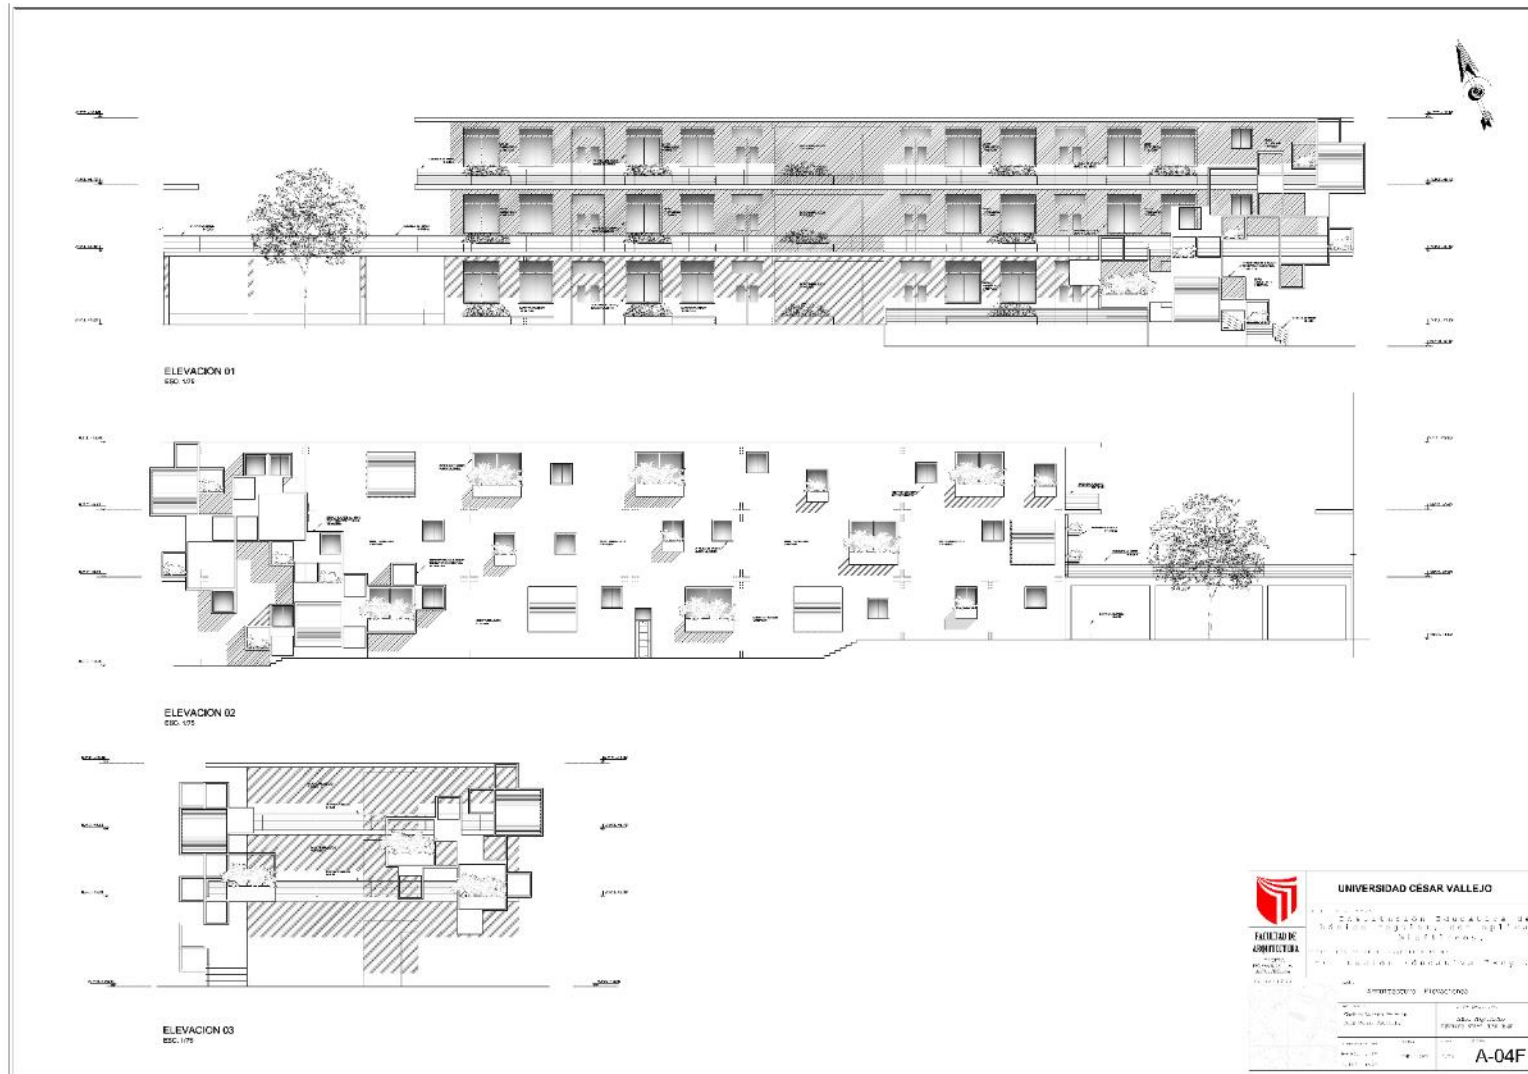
Plano Elevaciones bloque "F", Fuente: elaboración propia
